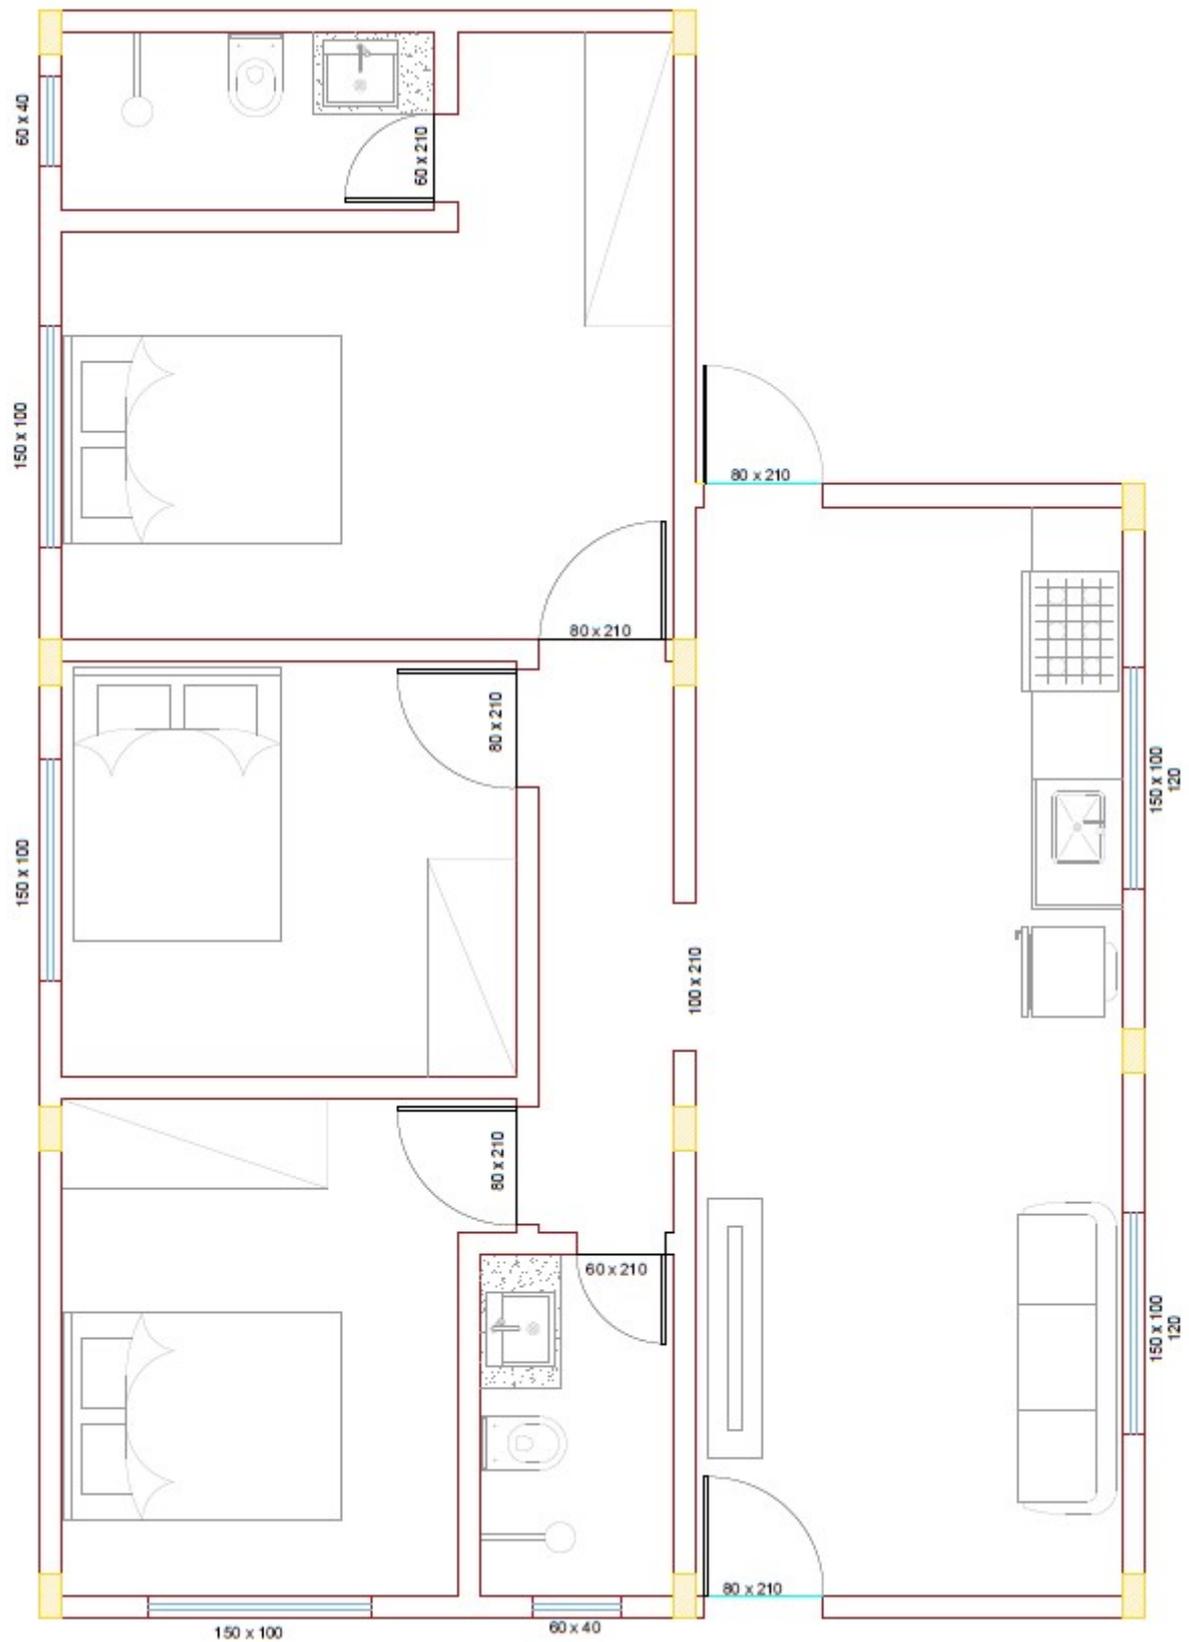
Planta Baixa com inserção de elementos estruturais (Pilares).
